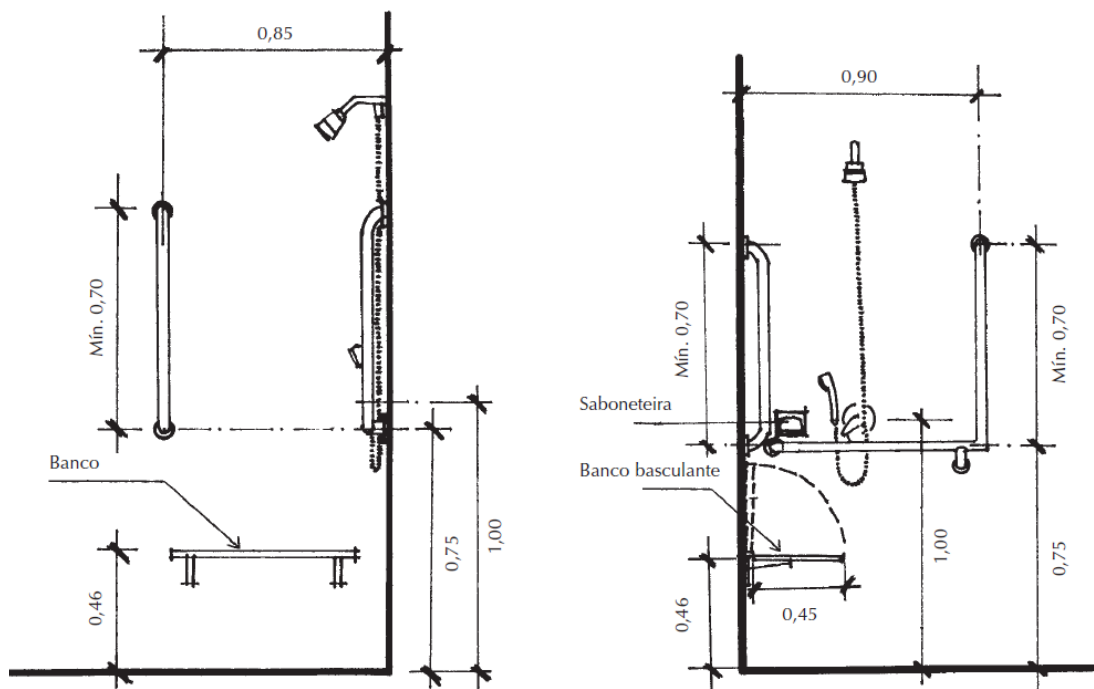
Vista lateral e frontal do chuveiro, respectivamente (SMPED, 2008).
